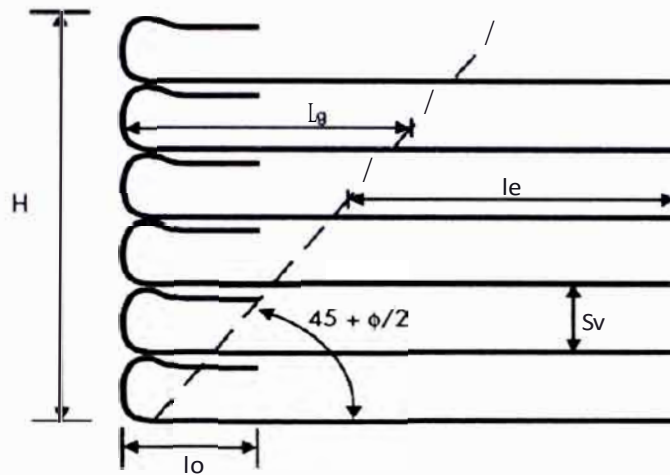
Longitudes de desarrollo del refuerzo con geotextil.
